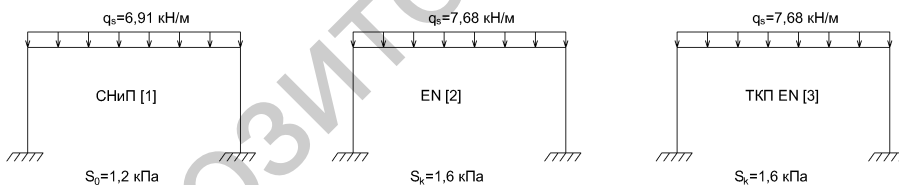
Схема приложения снеговой нагрузки на кровлю
